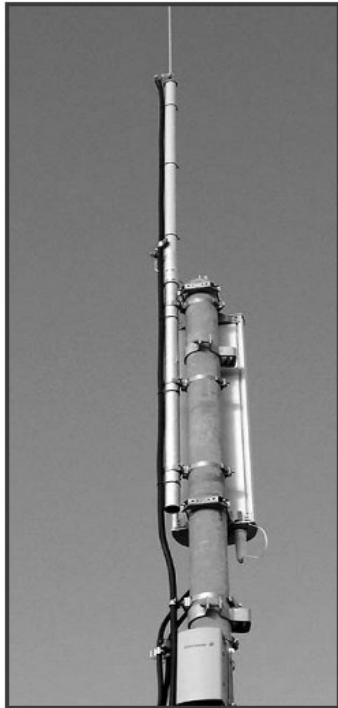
Opvanginrichting en geïsoleerde geleider voor een telecominstallatie, elektrisch gescheiden van de bouwconstructie – toepassing van het DEHNconductor systeem.
